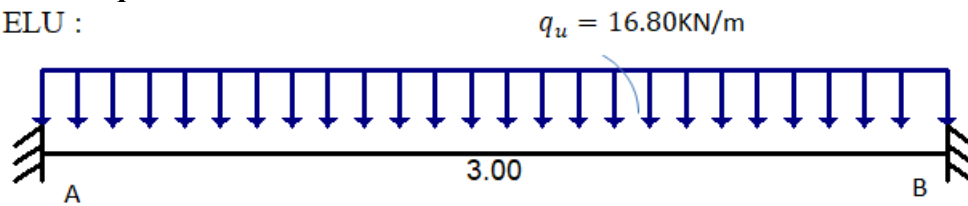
Schéma statique de la charge appliquée sur la poutre de palier (ELU)
